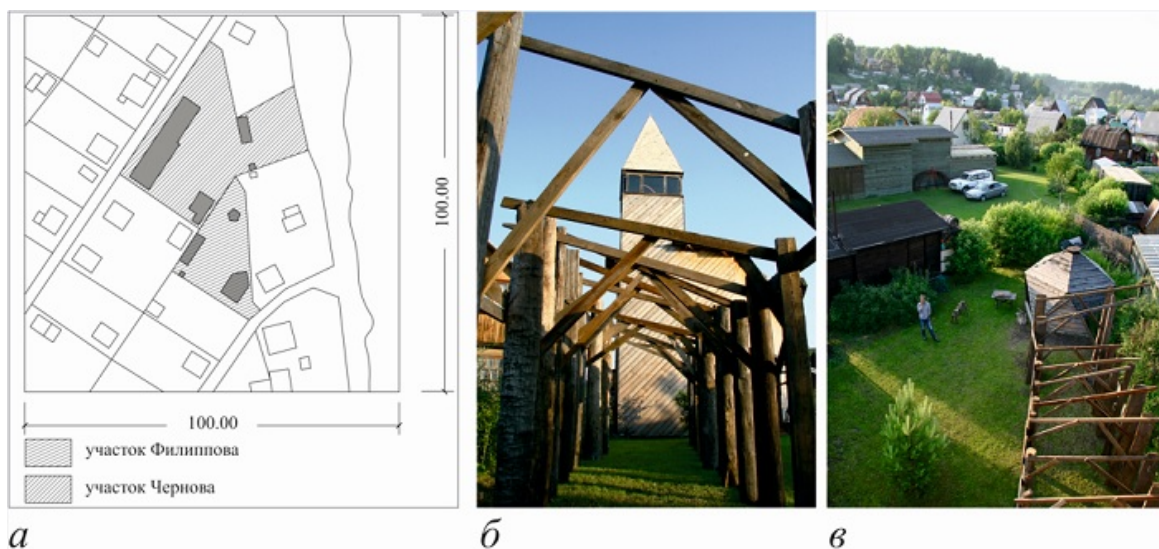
Дача А.А. Чернова: а — схема генплана; б — вид на башню; в — вид сверху на участок из смотровой площадки башни
